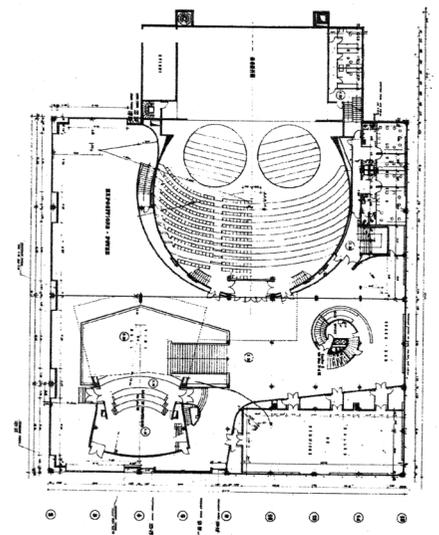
Grundriss / Kulturhaus Amien
